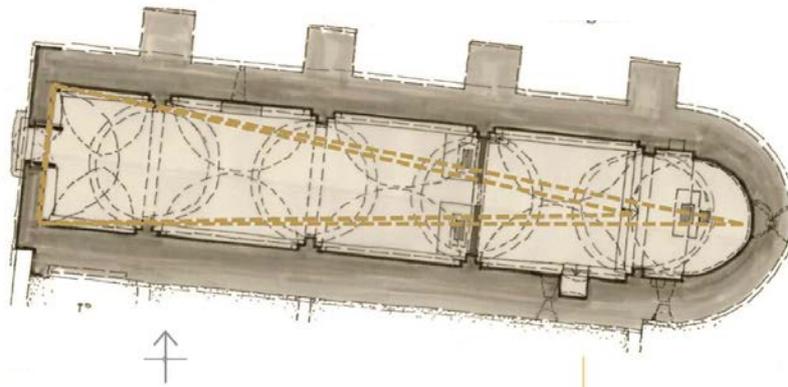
Plan et coupe de la chapelle Notre-Dame du Revest (CNRS – PRSP Sésames)
